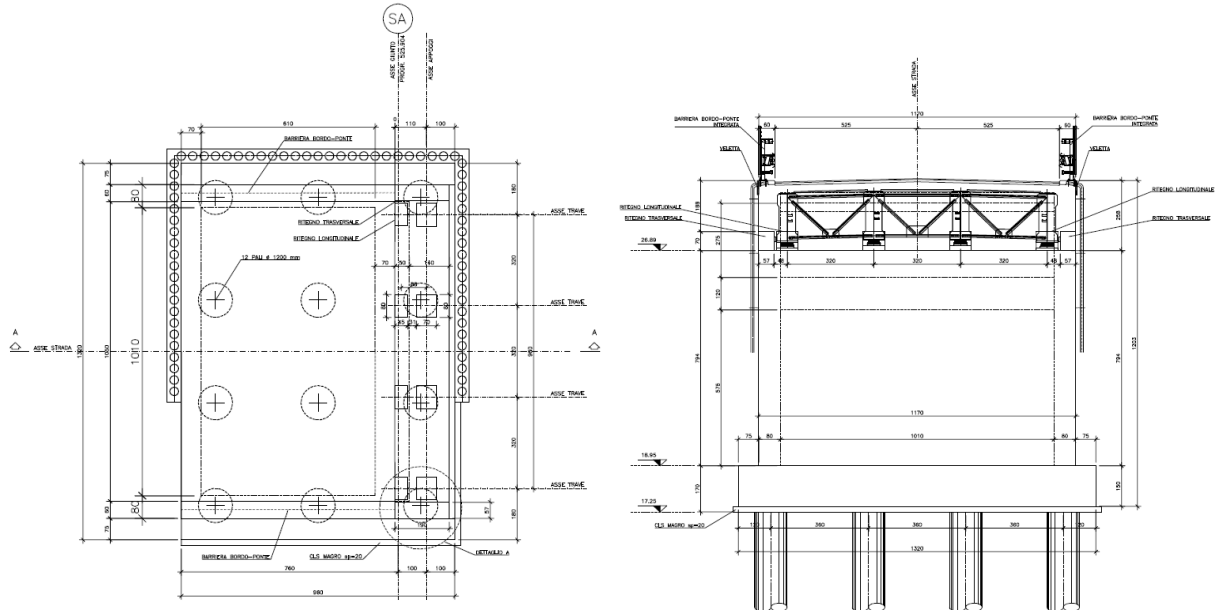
Pianta e prospetto - Spalla A
